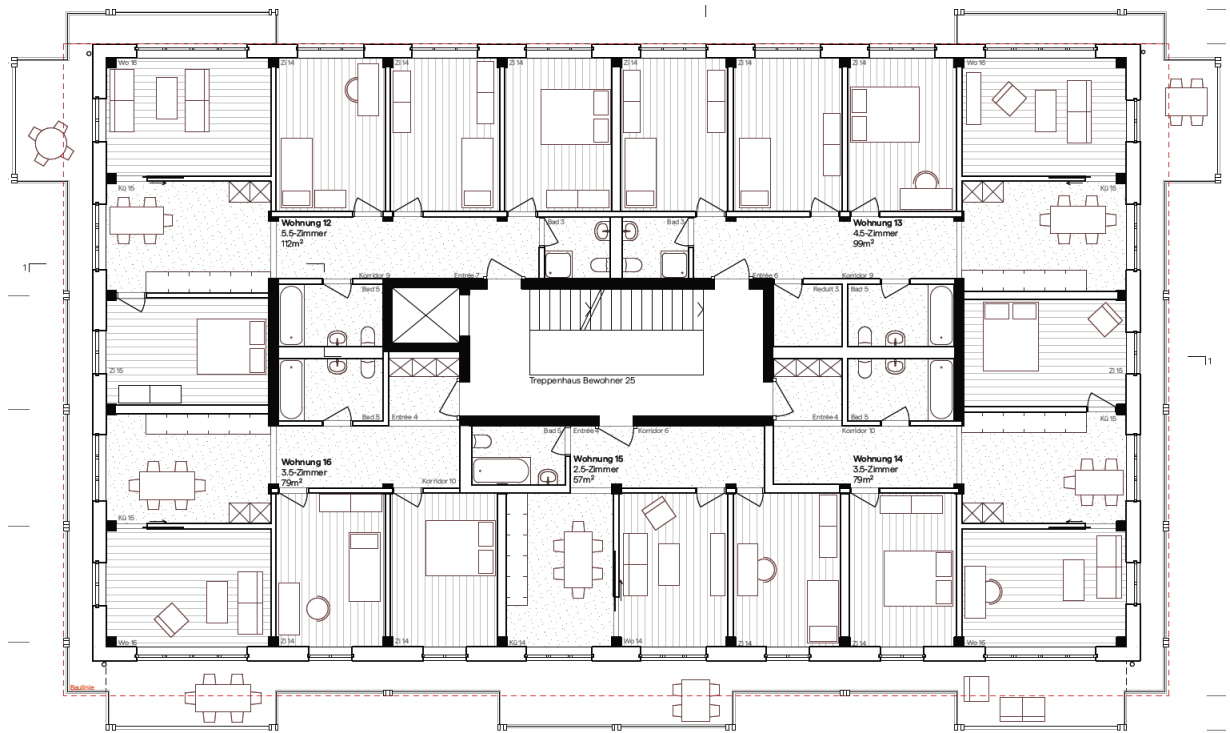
Grundriss Regelgeschoss, ohne Masstab
